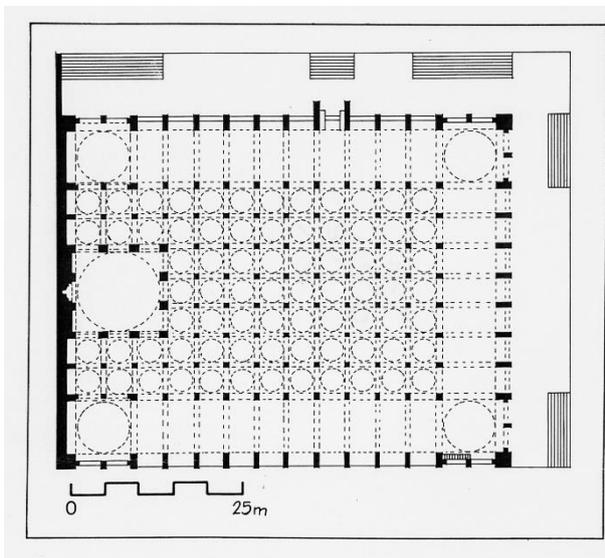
plan de la *ġamī' masġid* de Gulbarga, Cousens, 1916.
